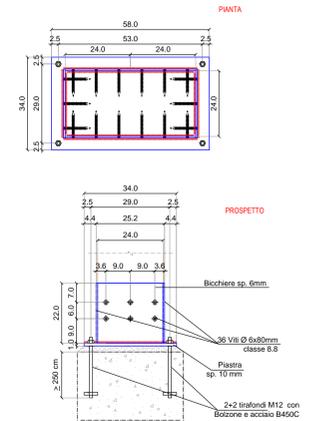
PLATEA DI FONDAZIONE - ANCORAGGI PILASTRI - Scala 1:100
